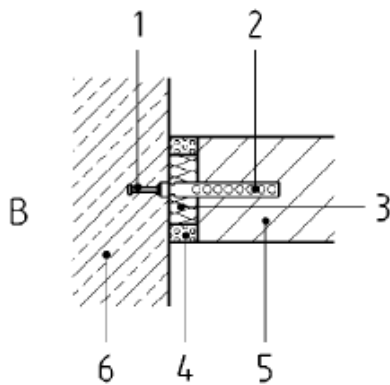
Liaisons avec un joint de dilatation entre les murs en maçonnerie, ou entre un mur en maçonnerie et un mur en béton
